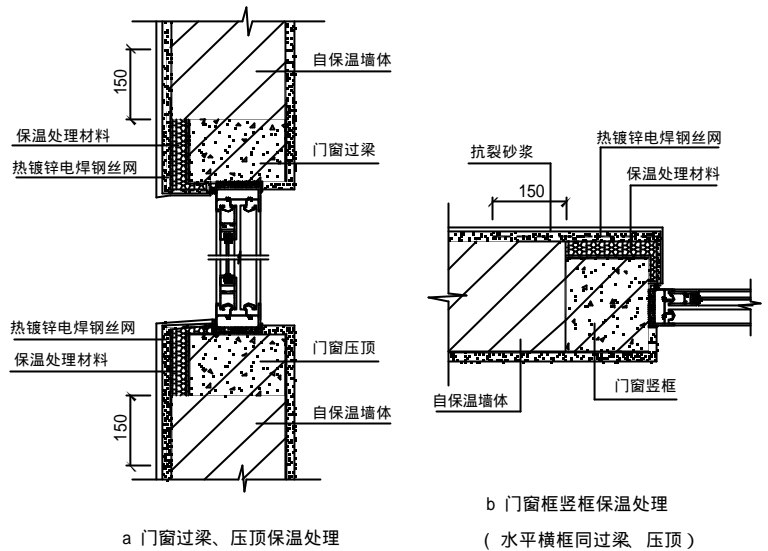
门窗过梁、压顶、钢筋混凝土框保温处理
